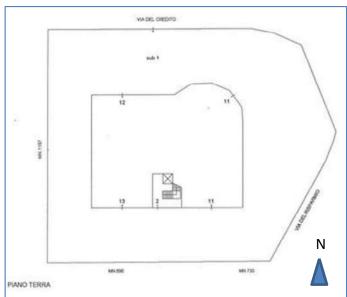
planimetria del lotto e collocazione dei due mappali n. 12 e 13
